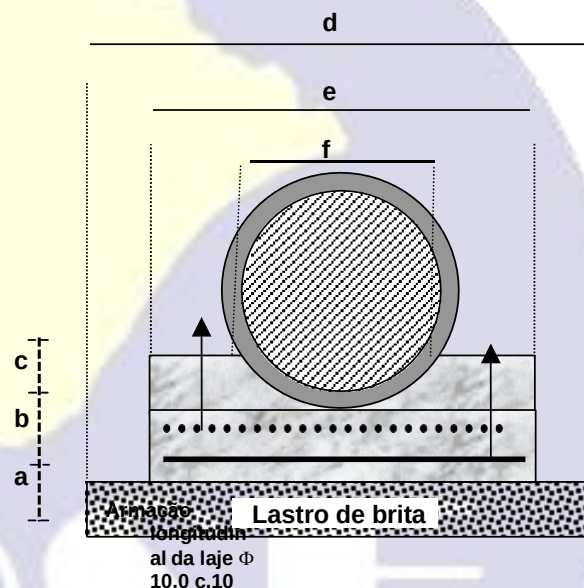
Lastro, laje e berço de concreto - dimensões em função do diâmetro do tubo
